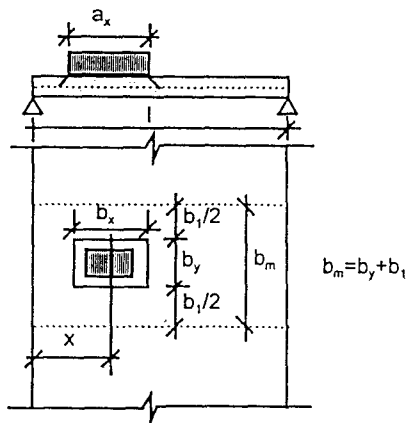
Distribuição de cargas em lajes armadas numa só direcção
